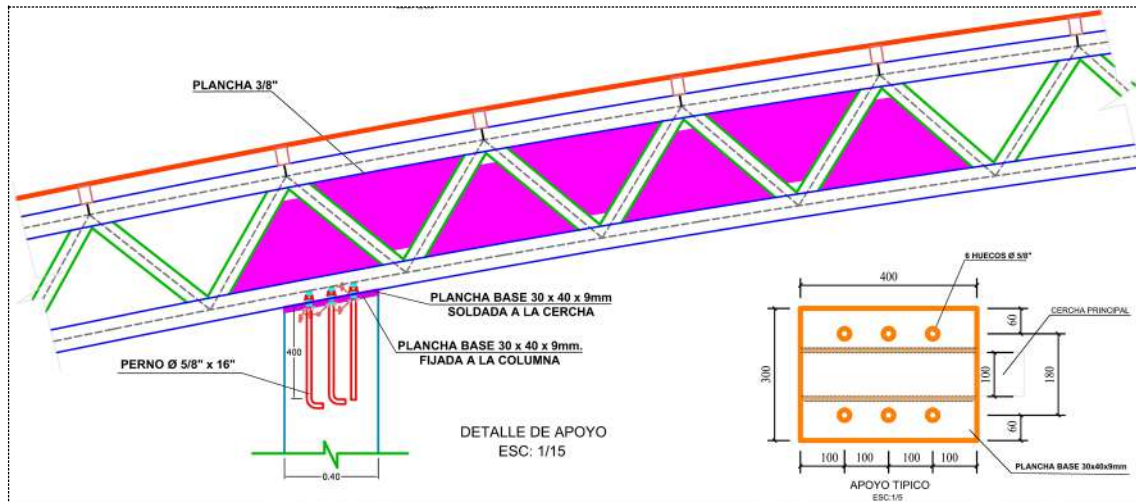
Detalle típico de soldadura, incompleto.
